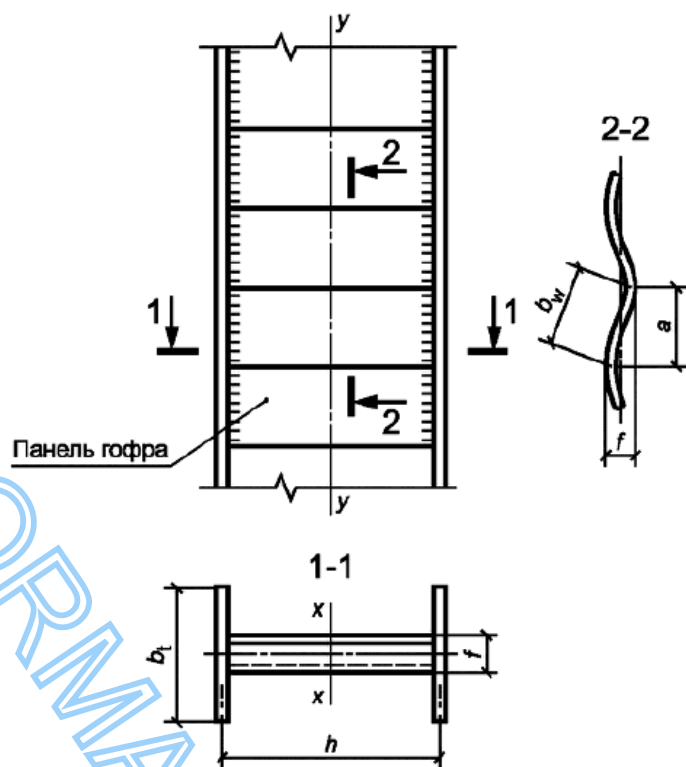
Колонна из сварного двутавра с поперечно-гофрированной стенкой с треугольной формой гофров
